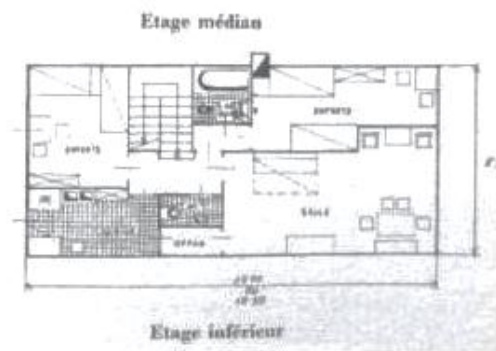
L'Ilot Insalubre*, planta do tipo 1, rua lateral - Simplex
